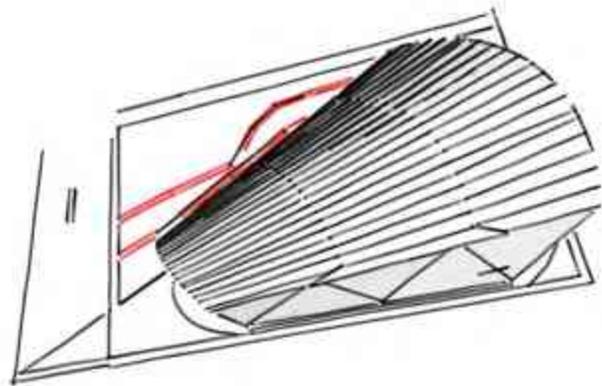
Croquis del lado sur del auditorio. F.M.P.
